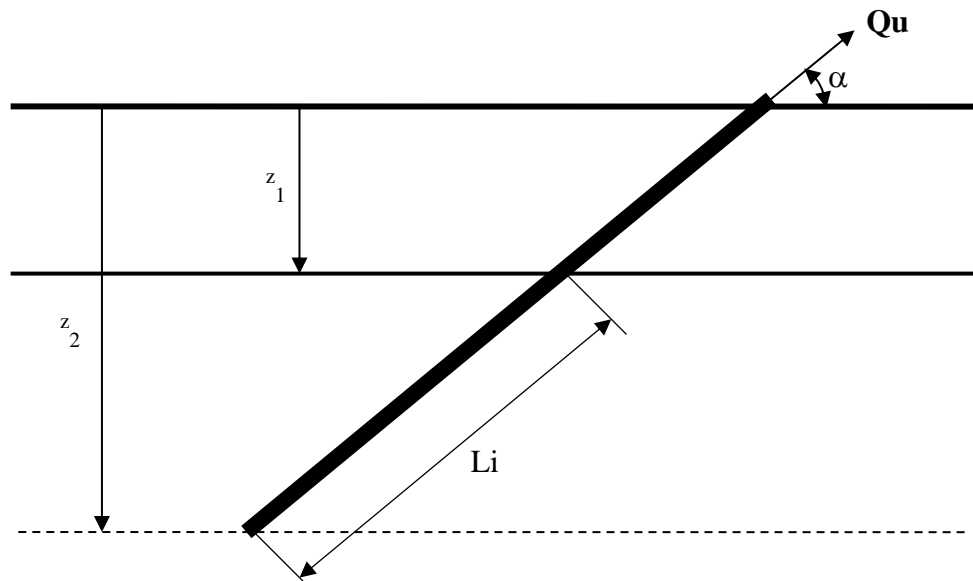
Esquema de cálculo de un anclaje inclinado, construido con el sistema IGU
